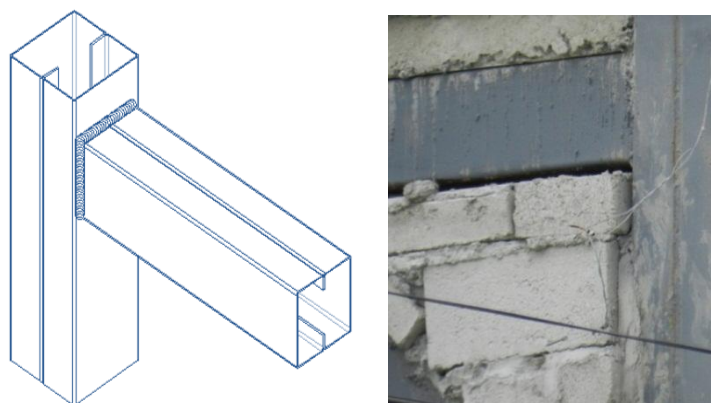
Soldadura a filete (conexión columna-viga)
